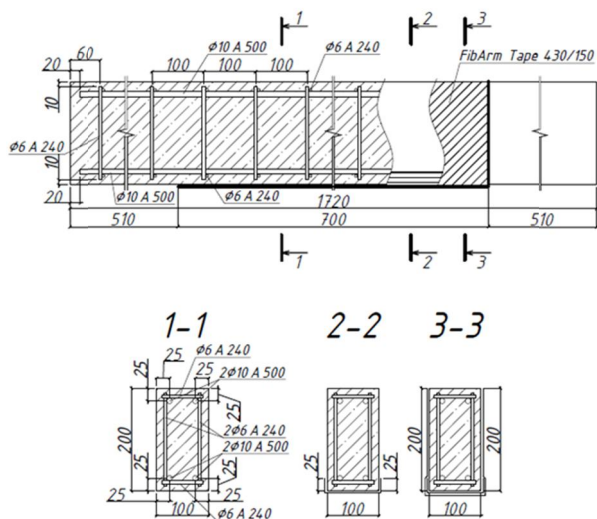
Схема изготовленных железобетонных балок серии Б2
